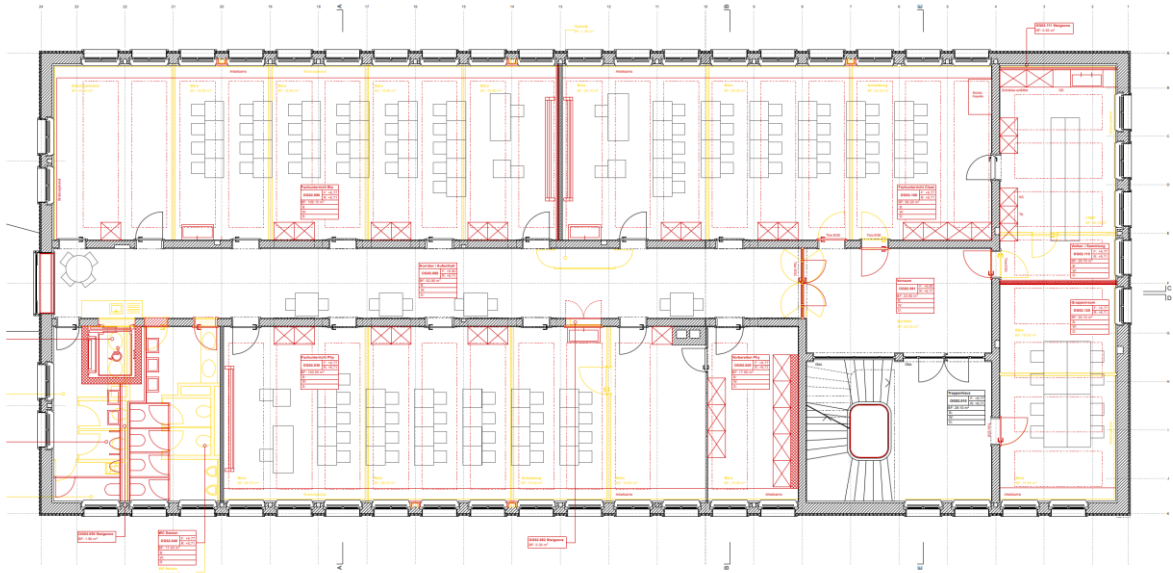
Grundriss 1. ObergeschossAbbildung 4: Grundriss 2. Obergeschoss
